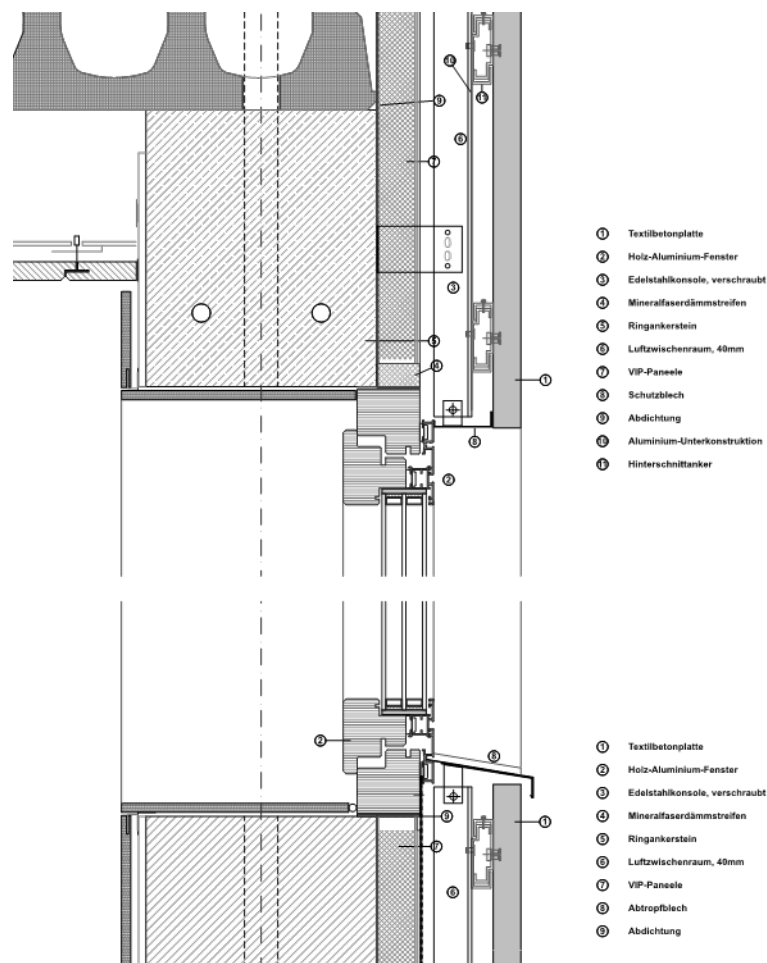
Fensteranschlussdetail bei VHF-Fassadensystem (Prinzipdarstellung)
